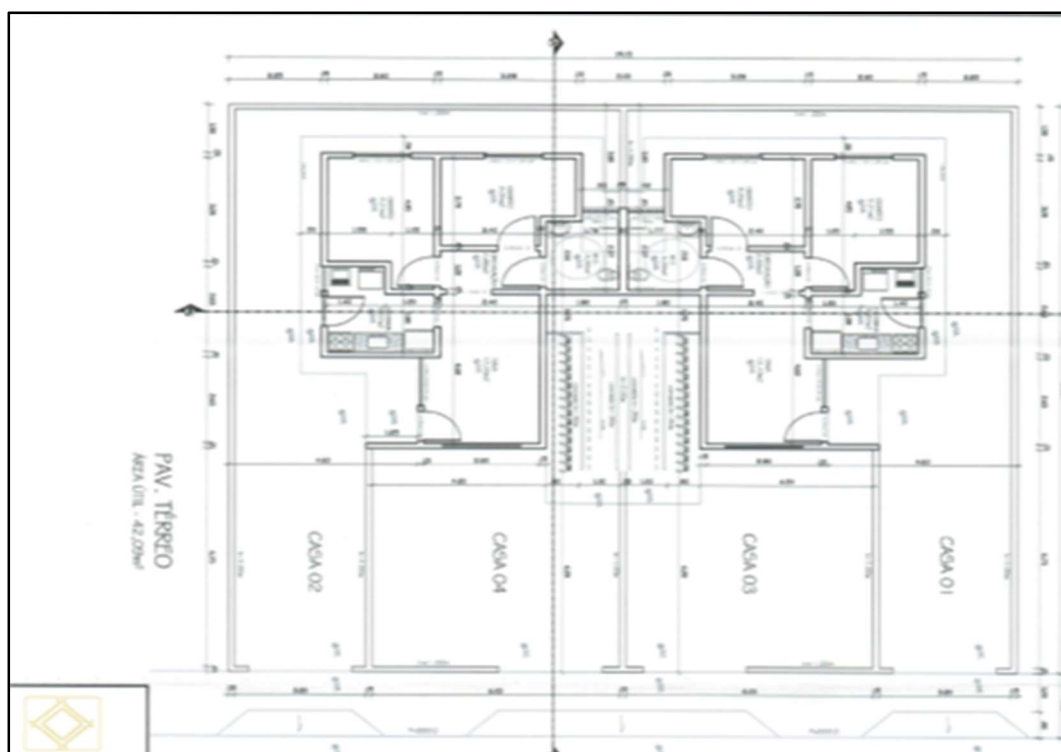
Bloco de Unidades Habitacionais- Planta Baixa.
